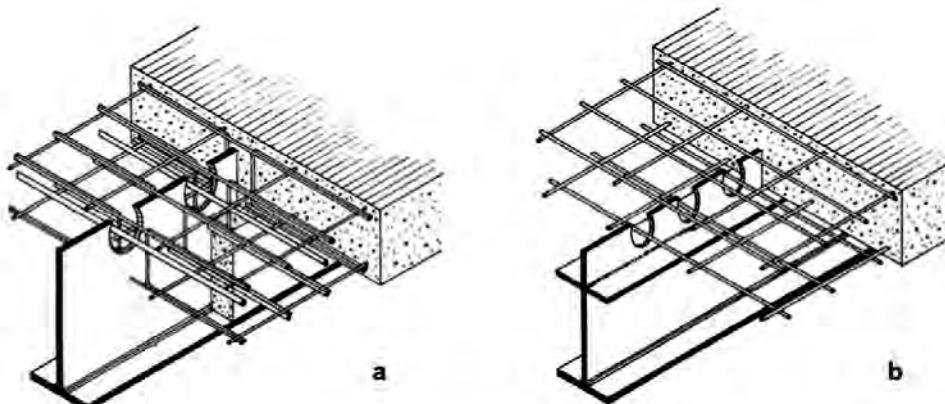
Конструкция объединения бетона и стали [7]: а) в специальной полосе; б) в стенке балки
